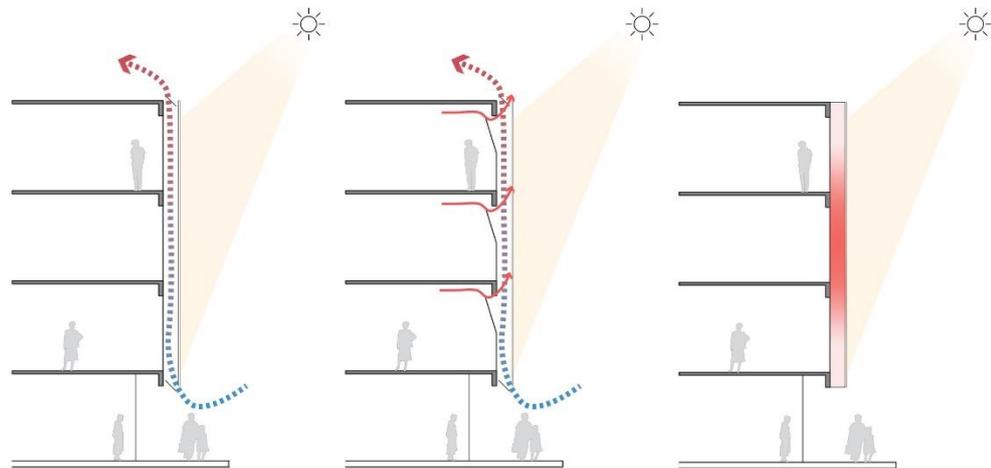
Esquema de comportamiento de la fachada ventilada. Fuente: Archdaily.
